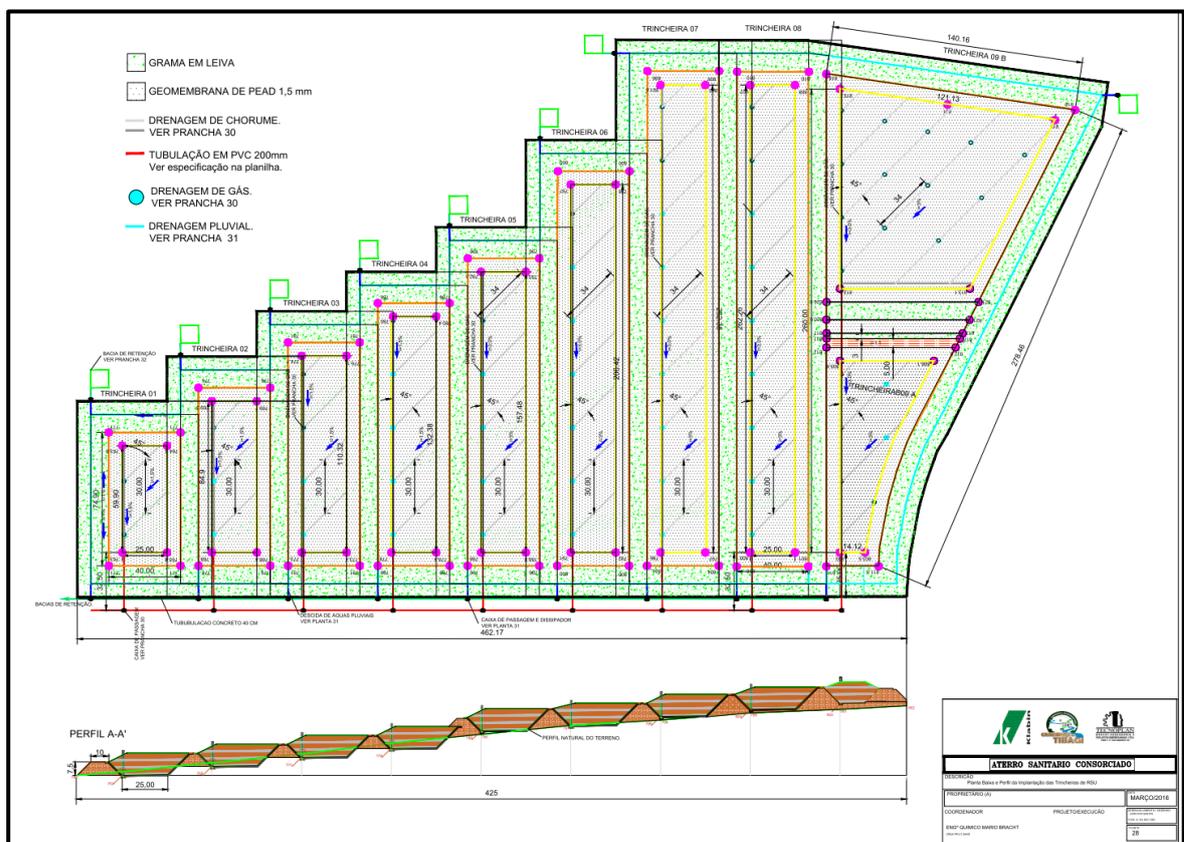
Planta baixa e perfil da implantação das células de RSU.
